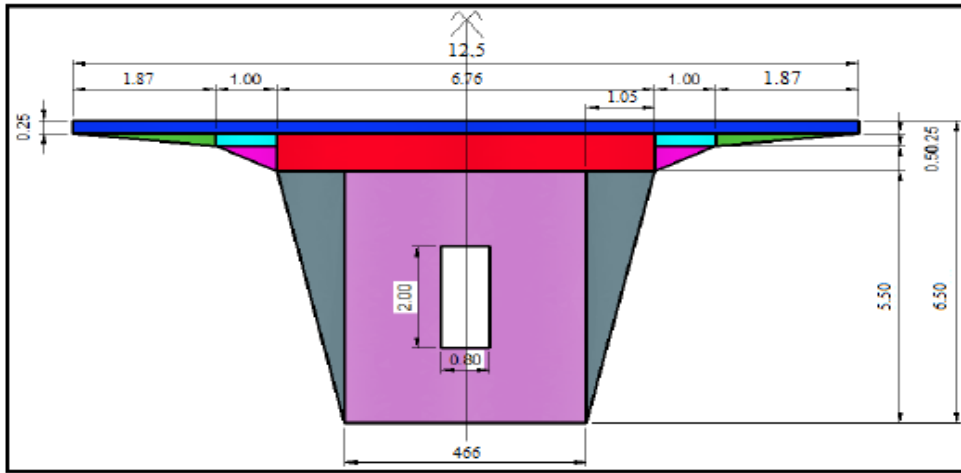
Coupe transversale du voussoir plein sur pile.
